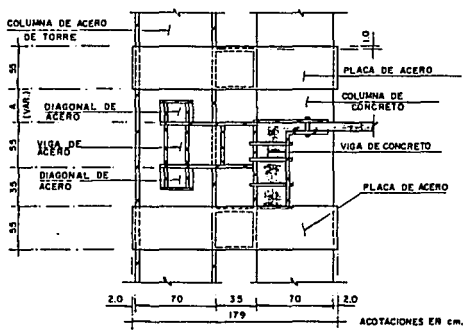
DETALLE DE CONEXIONES ENTRE VIGAS
